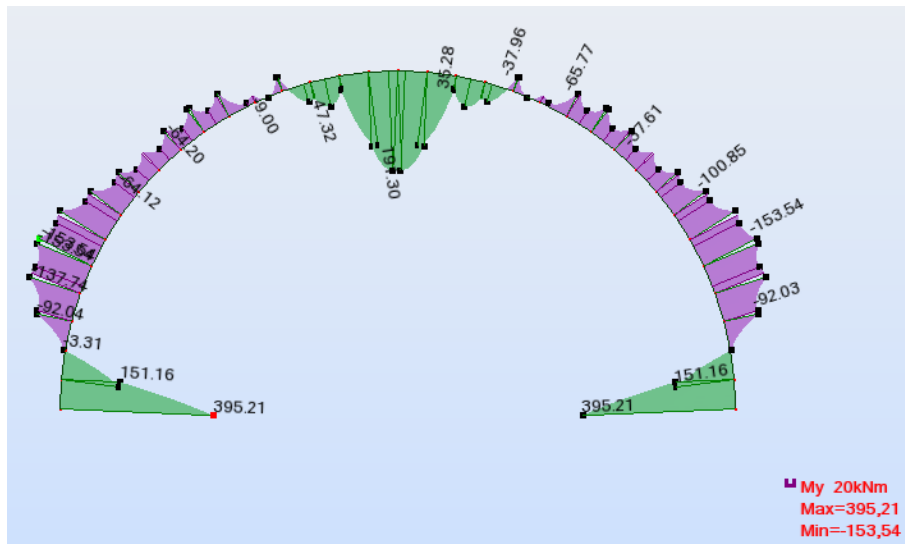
diagramme du moment fléchissant du soutènement provisoire de la section Est
